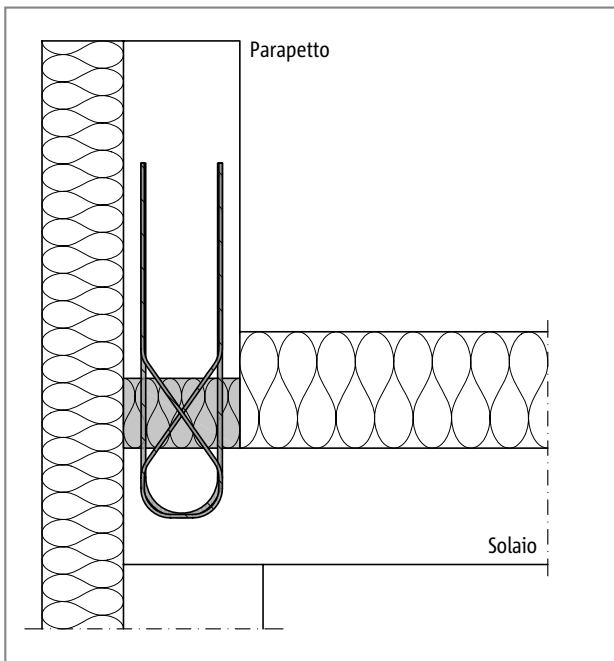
Schöck Isokorb® tipo ABXT - disposizione verticale, parapetto sovrapposto
